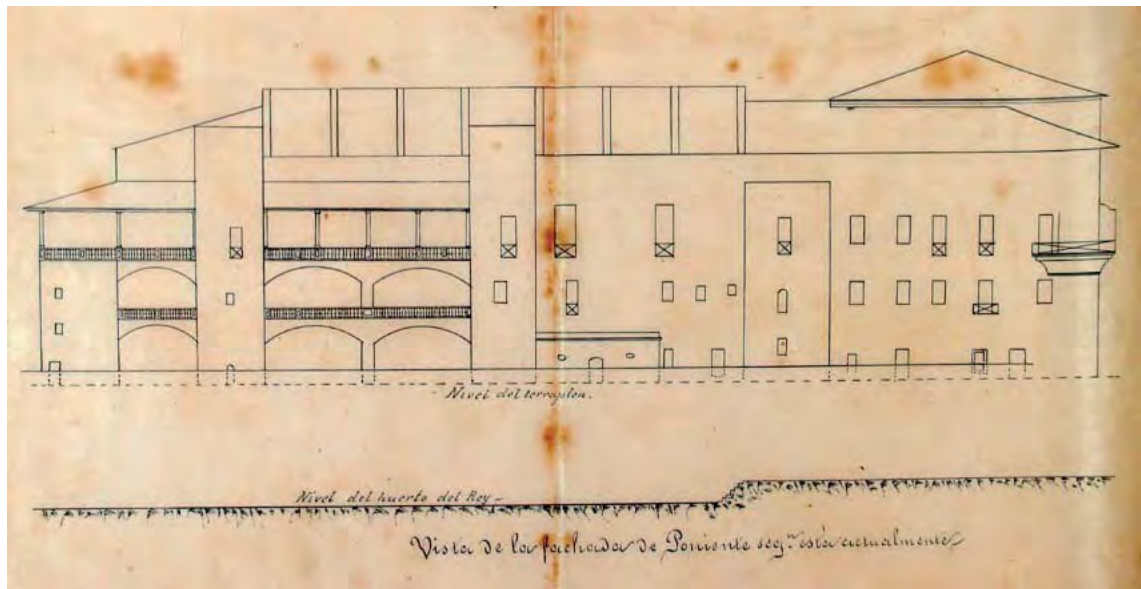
Plano del proyecto de 1885 para la fachada oeste: estado original y proyecto de cambio de cubiertas y nuevo almenado de las torres (ARMBAL, 799/3)
